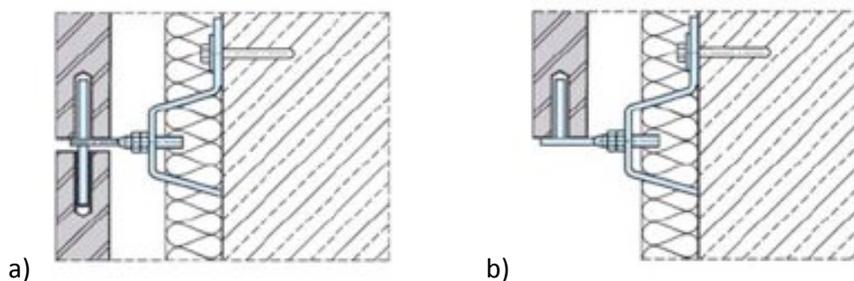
Esquema em corte de gatos metálicos: a) aplicado em zona corrente b) aplicado numa zona de arranque [19]
